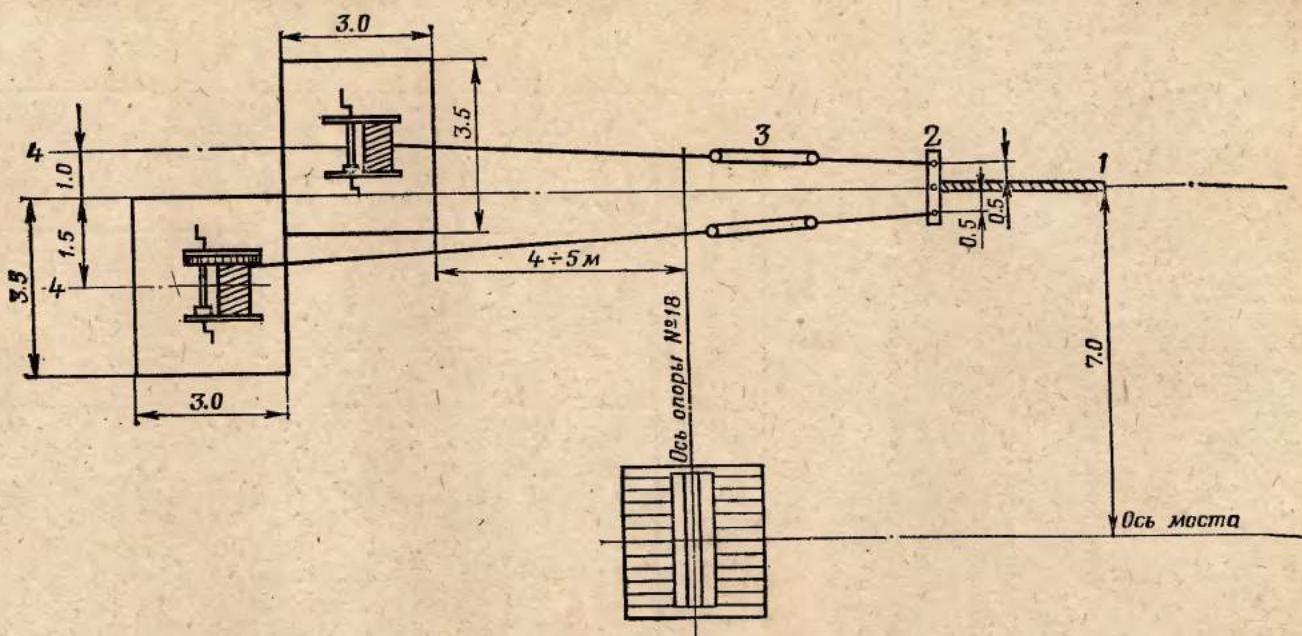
Установка лебедок усиленного продольного закрепления наплавного моста:
